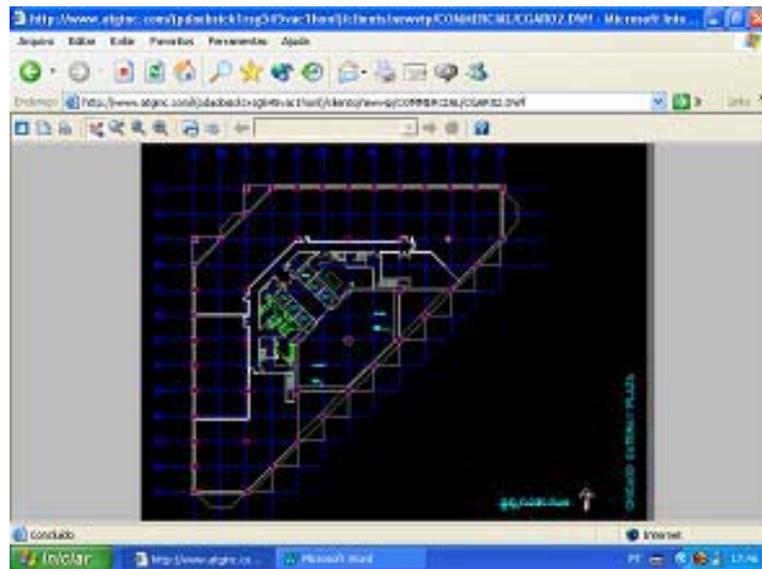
planta baixa arquitetônica com apresentação da estrutura (AVS, 2004)
